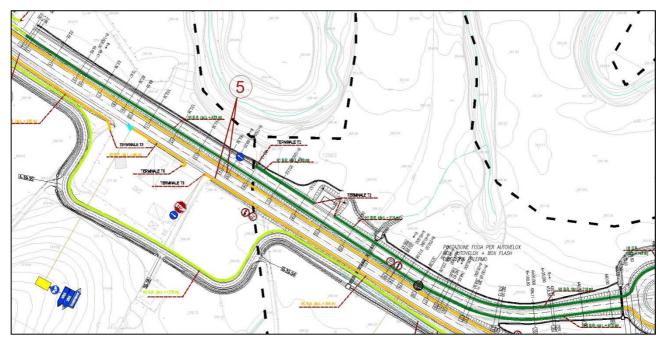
Stralcio planimetrico barriere di sicurezza, tavola PED PE\_SB\_P024\_40\_4137
